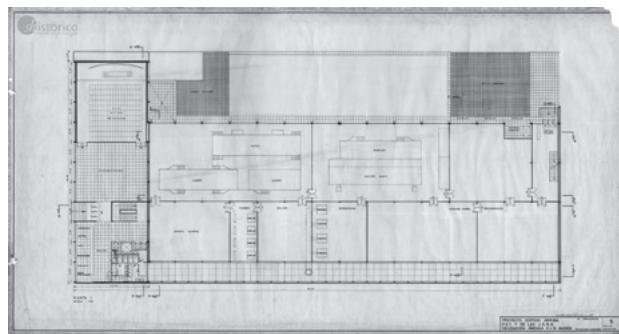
Diario Arriba. Planta baja. Legado 02 FCT_P155_Plano 03.
